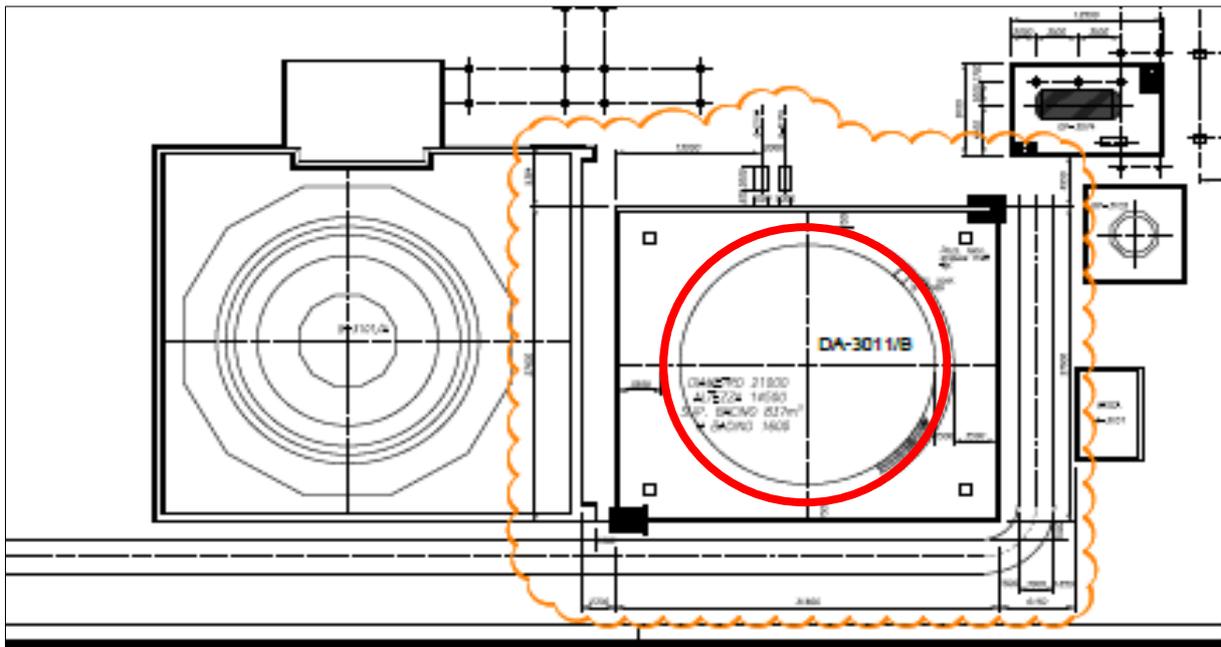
Posizionamento planimetrico nuovo serbatoio stoccaggio acque reflue in zona 50 sud impianto di Cracking
